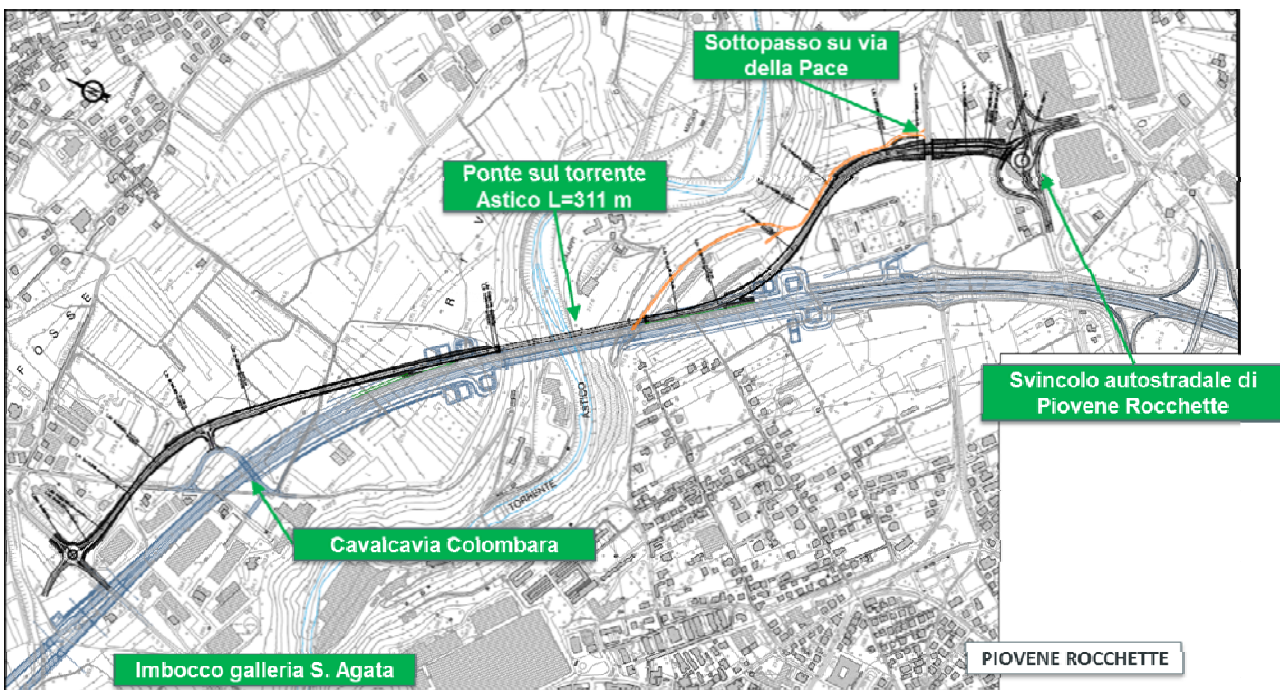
Planimetria Bretella Piovene Rocchette- Cogollo del Cengio
